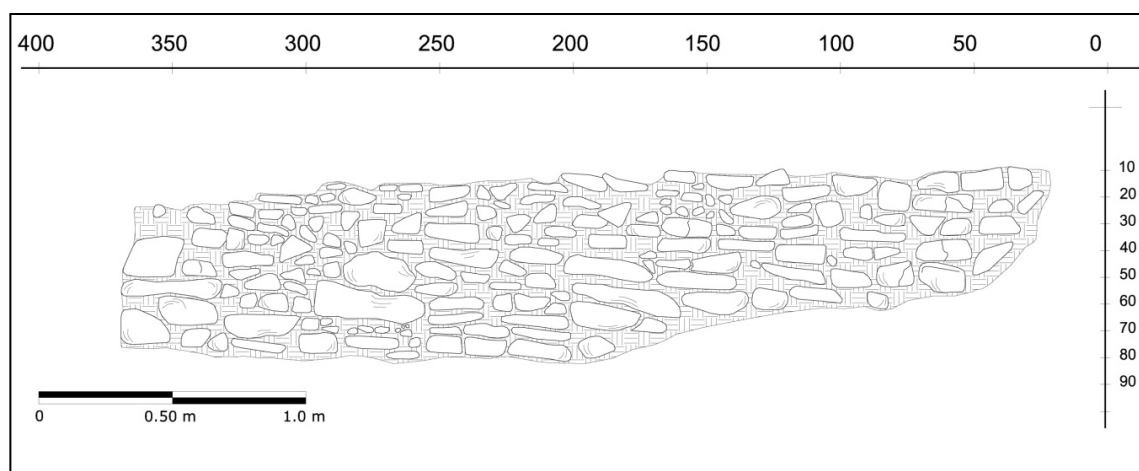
Muro de mampostería. Costado este, interior estructura (3/2°-2).
